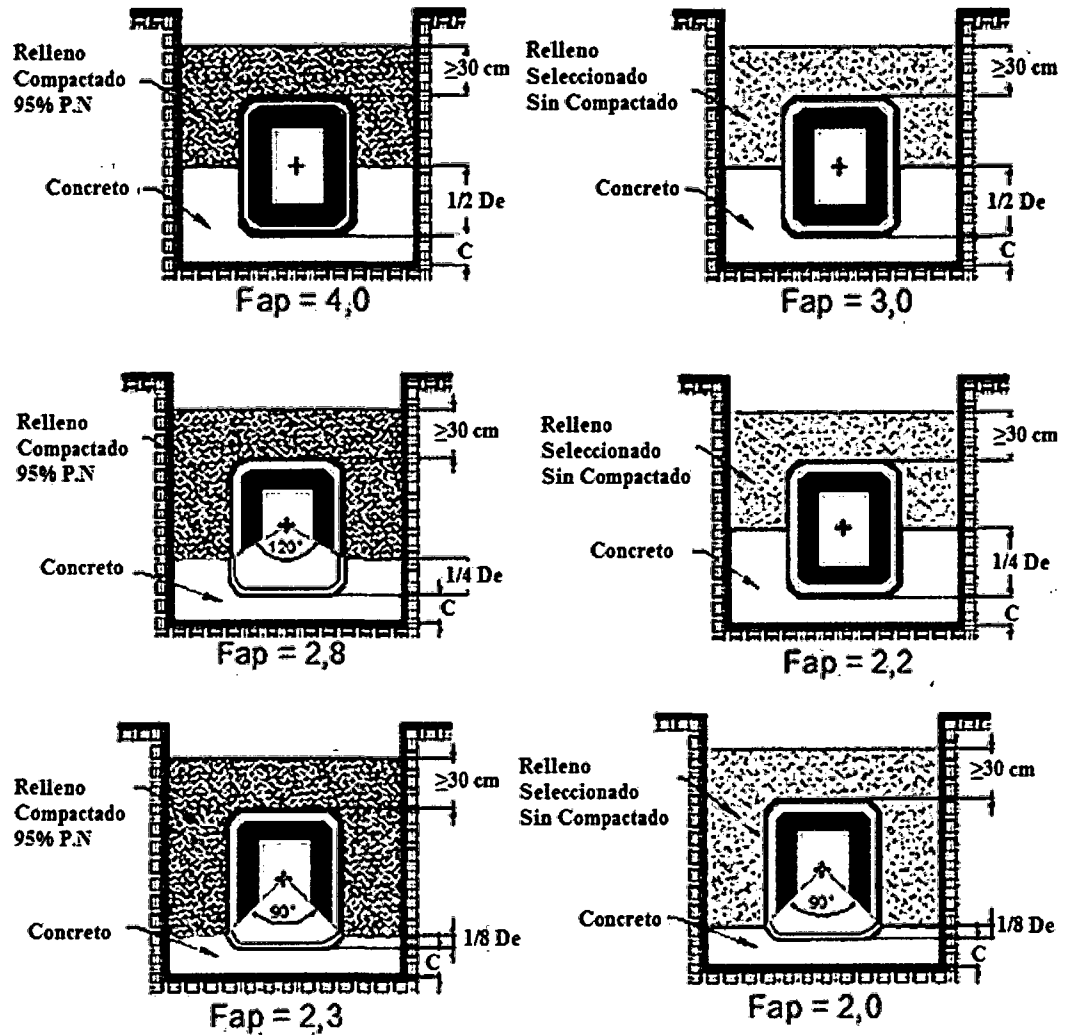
Factores de apoyo con plantilla de concreto (solado)
